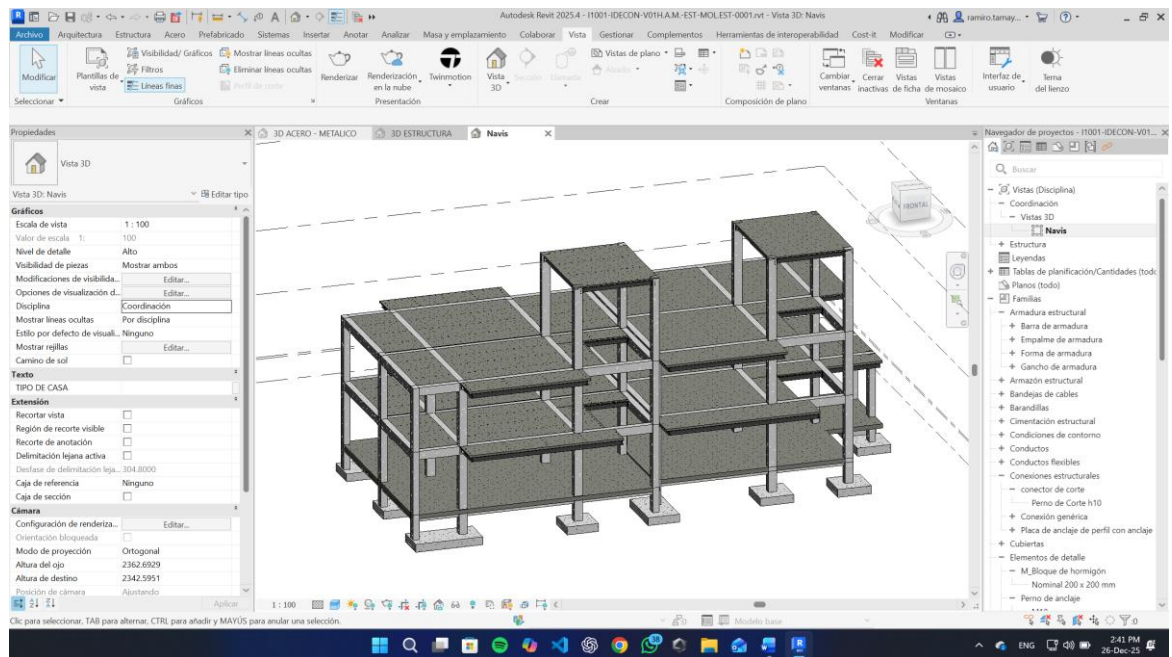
Carpetas por disciplinas en Revit: sistema mixto
